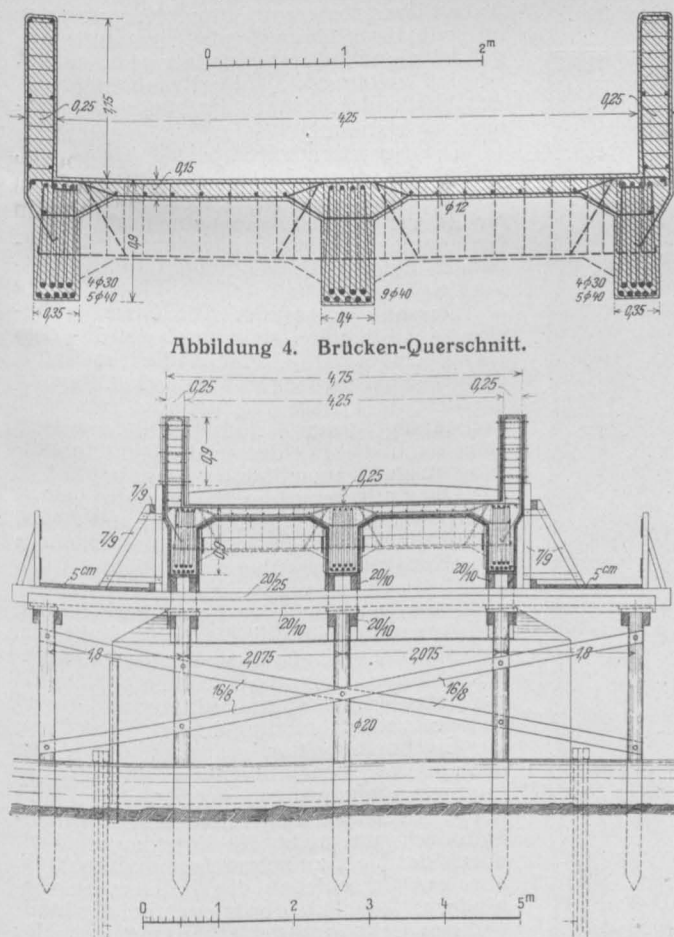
Querschnitt der Brücke mit der Einrüstung.
